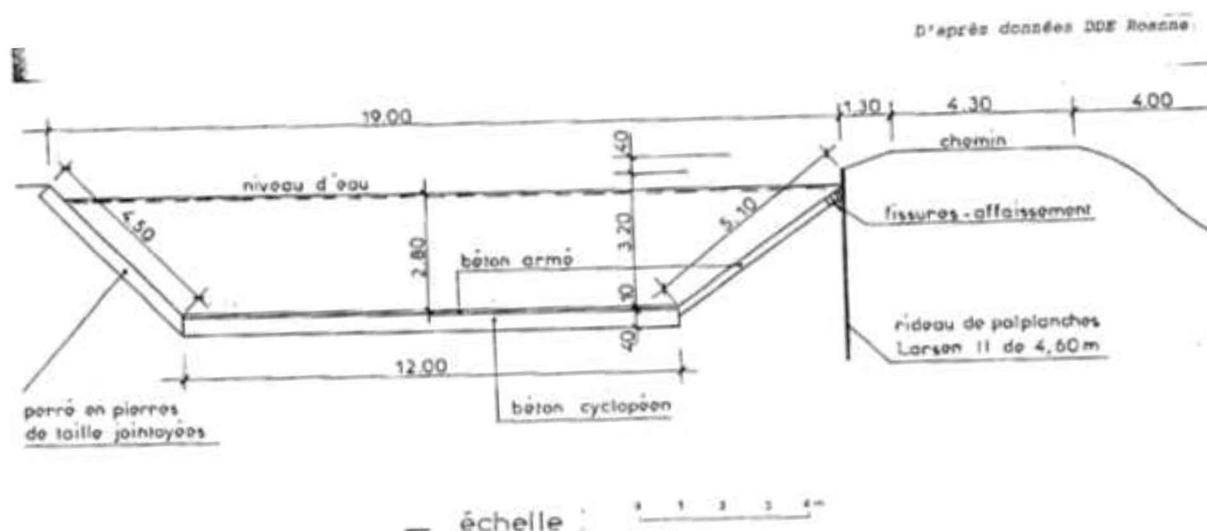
Coupe type du canal de Roanne à Digoin au droit du champ captant de Briennon (source DDE)
